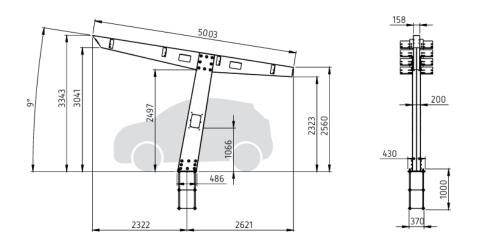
Vista lateral PVM1 (Fuente: Aplitech [22])
